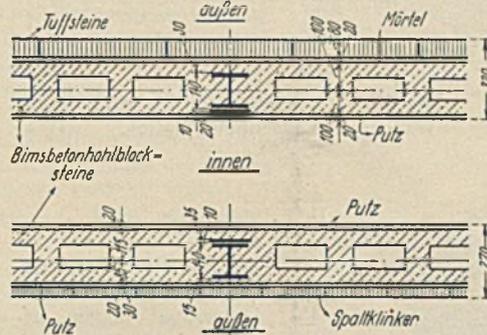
Wandausbildung des Bahnhofshotels, Oberhausen.
